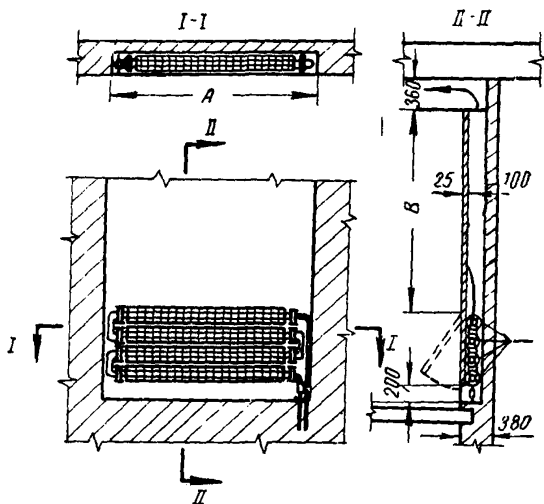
Конструкция рециркуляционного воздухонагревателя
